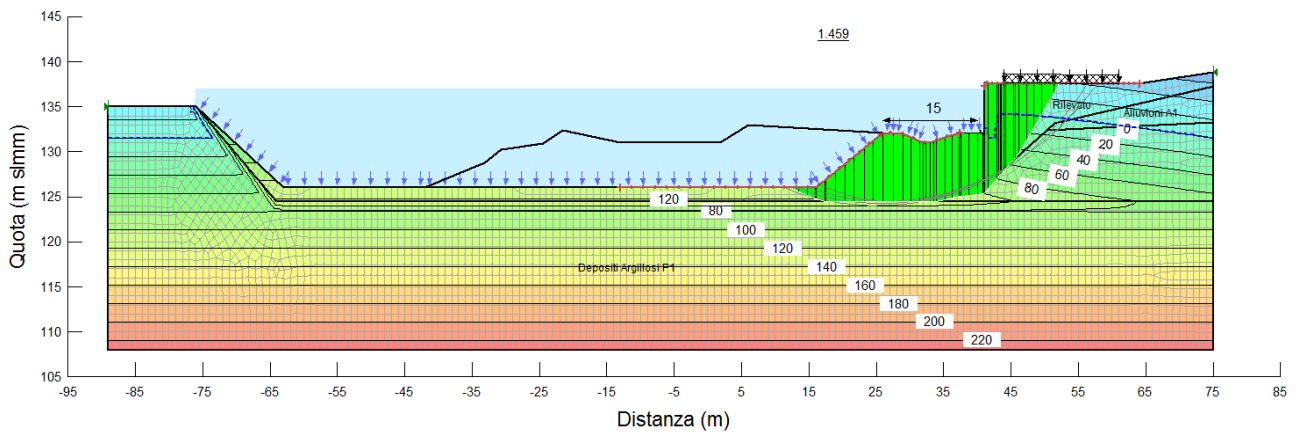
Sezione 16: Analisi di stabilità globale con scalzamento fino a 15 m a 20 h dall'inizio della piena con parametri fattorizzati
